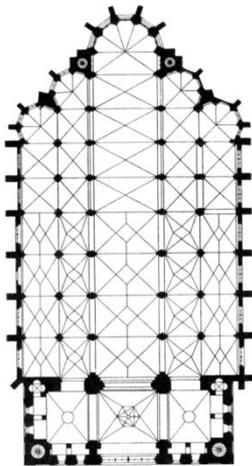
Xanten, Dom, Grundriss, 1263
